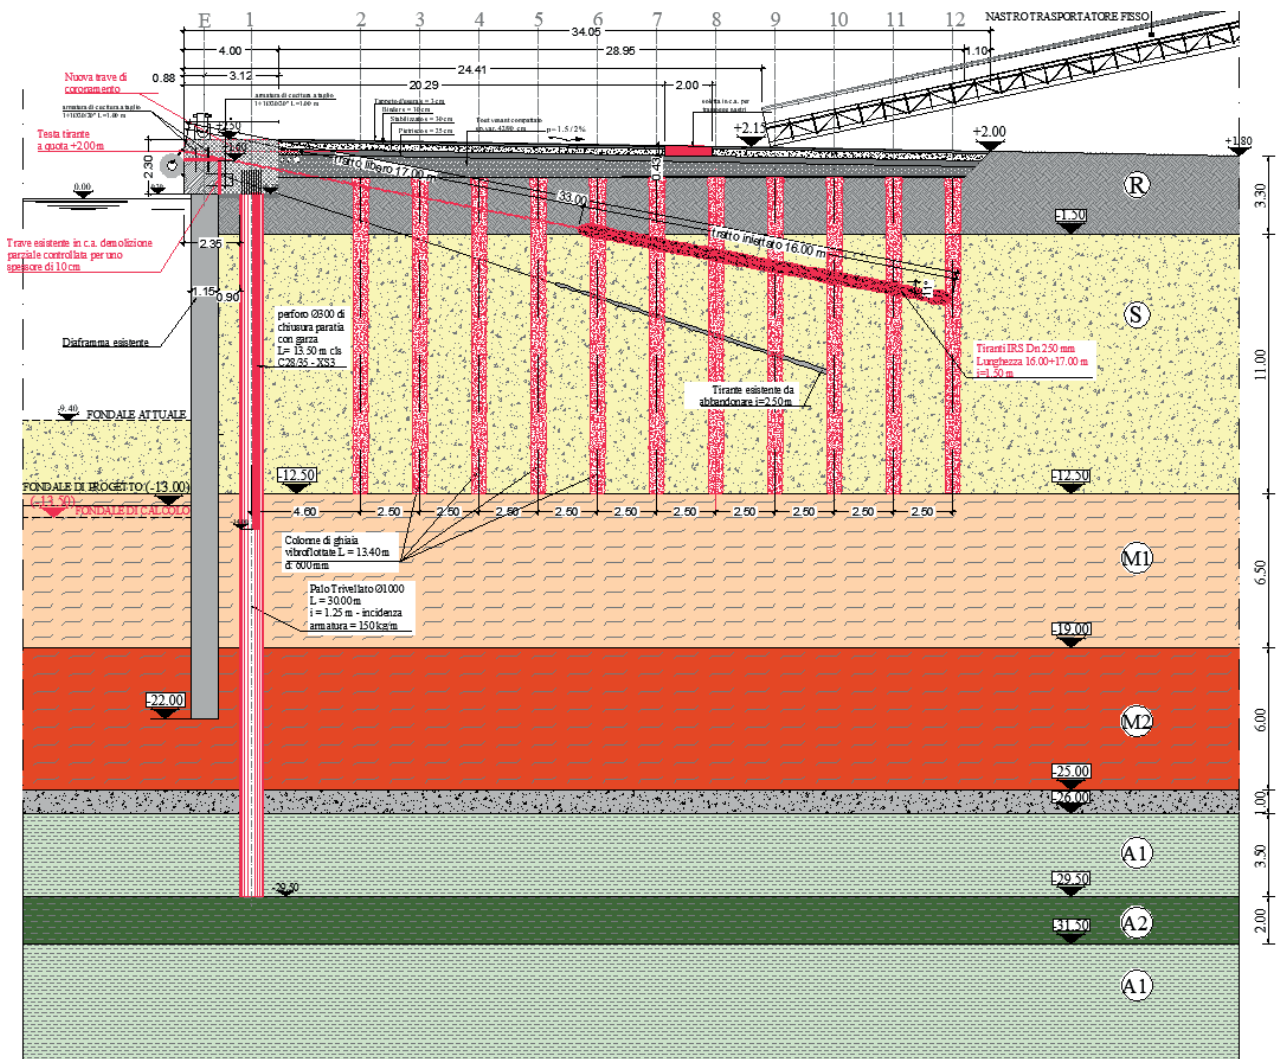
Sezione tipologica di progetto - Banchina IFA
